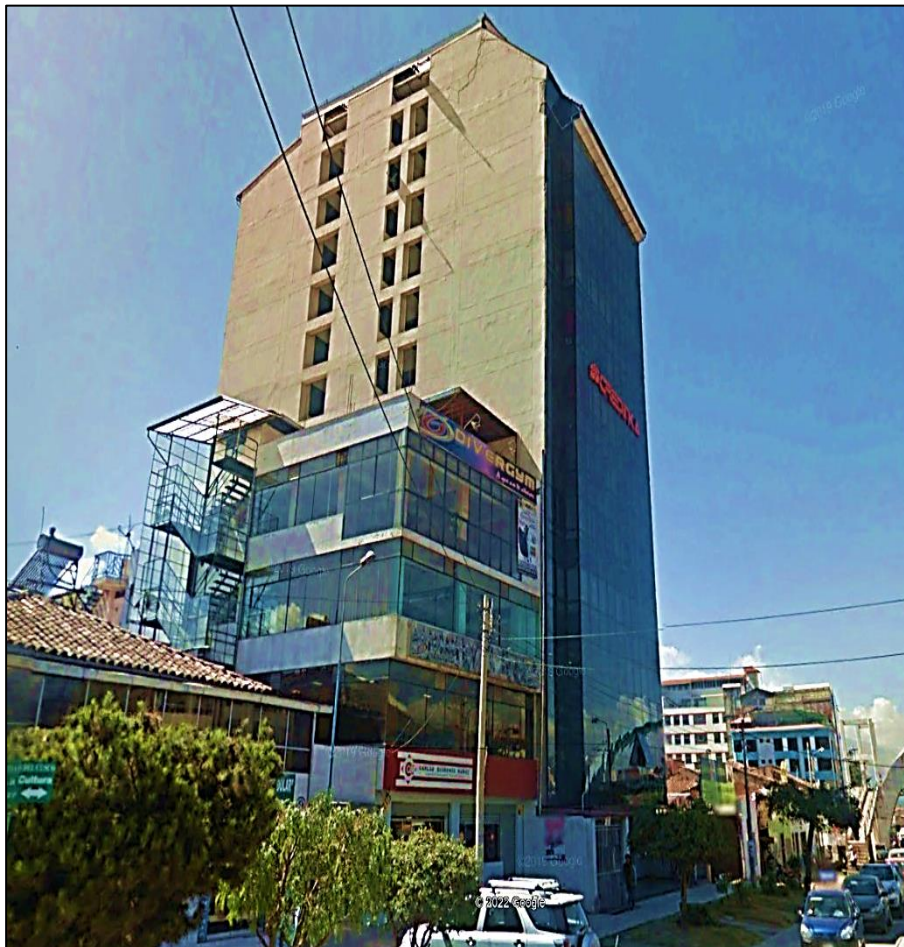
Ejemplo de estructuras adyacentes de concreto armado
